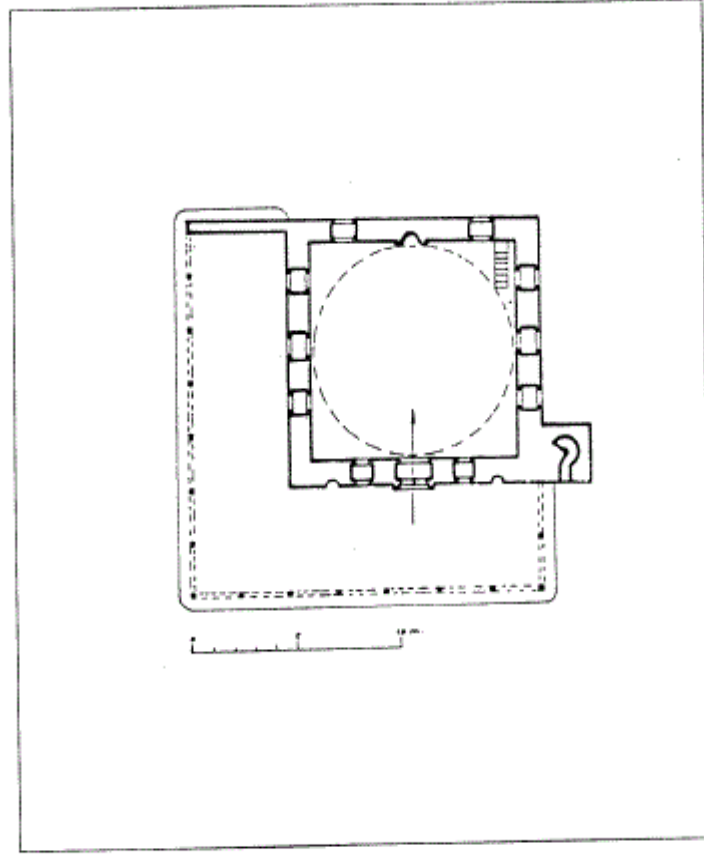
مسقط أفقي وقطاع لمسجد الأجا في فونجا (عن: Pašić).
